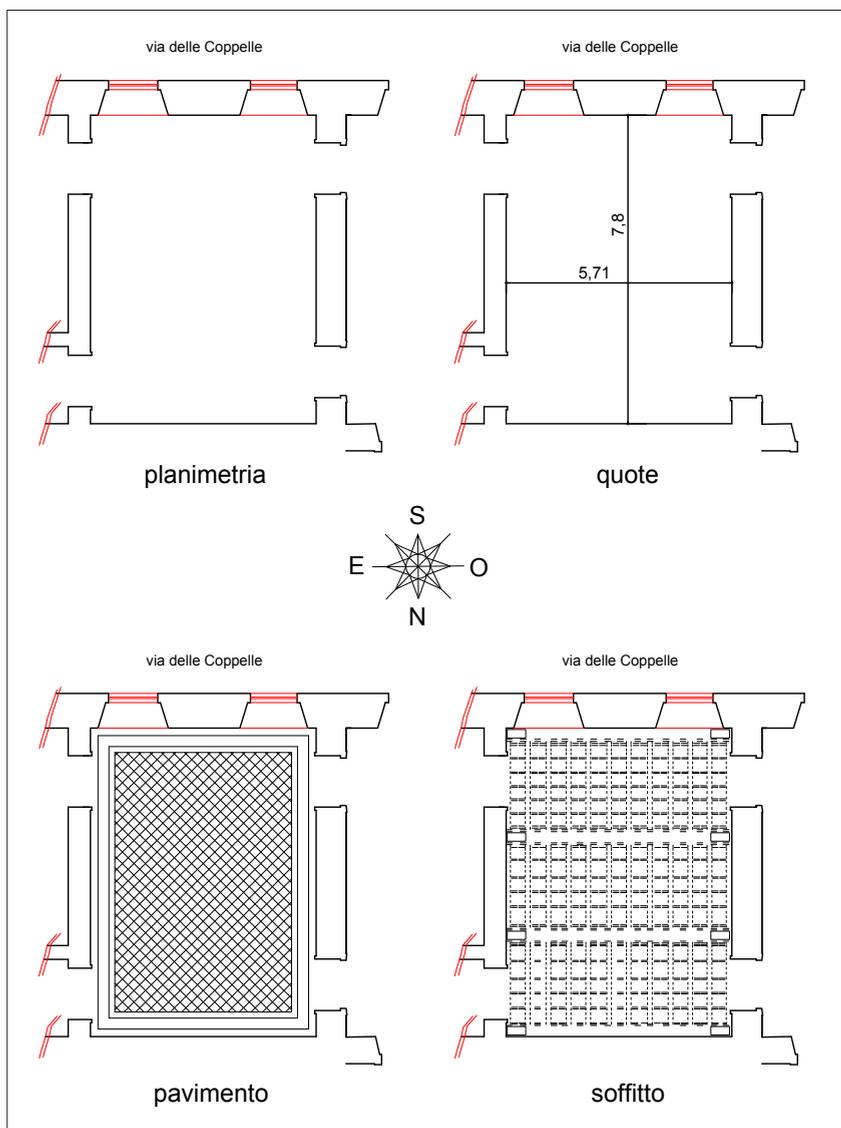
Planimetria quotata dello studio di Melchiorre Baldassini con proiezione di pavimento e soffitto (Arch. Marco Setti)
